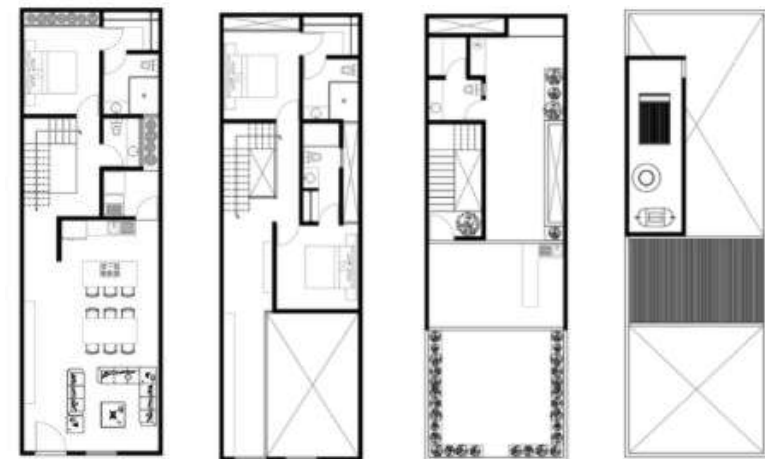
Planta Baja, Alta, Roof Garden y Azotea. Casa Cervantes.
